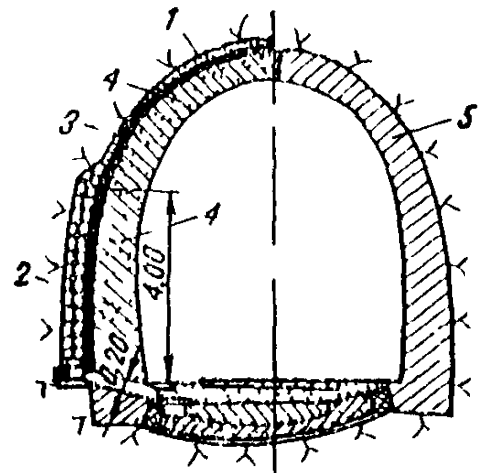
Дренаж и гидроизоляция обделки туннеля, [Л 30]
